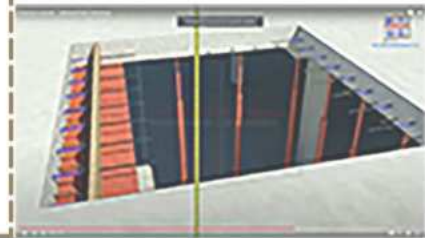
Disposición de cables inhibidora de la fisuración. [2]
